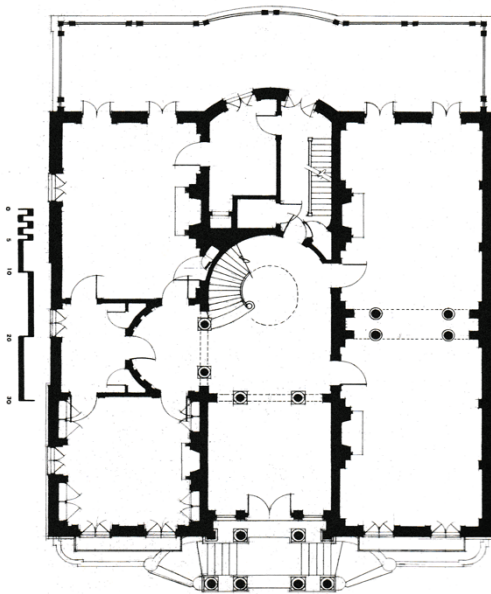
Der ursprüngliche Grundriss des Erdgeschosses (1850)
